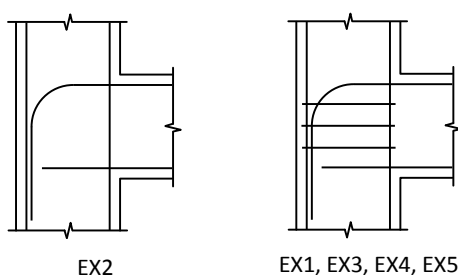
Pormenorizações da armadura das ligações viga-pilar (Sarsam [1983]).
